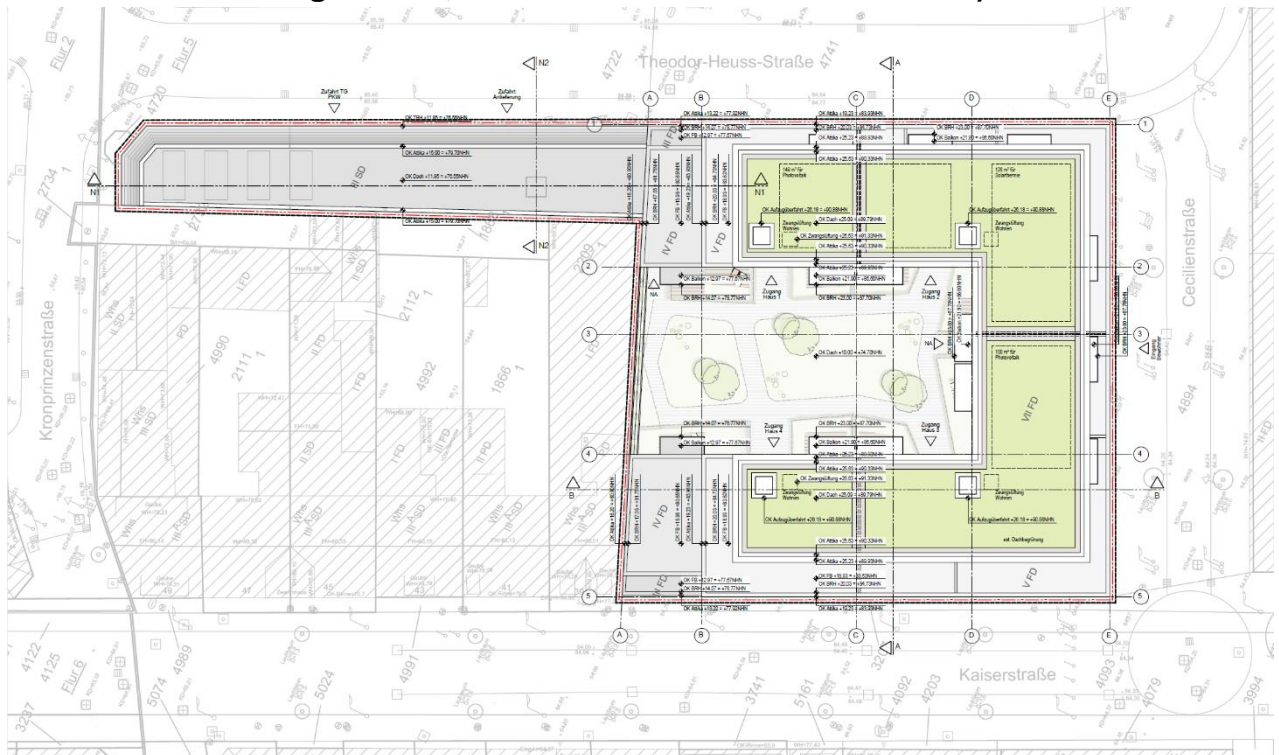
Ausschnitt des Lageplans mit Details der Dachaufsicht (ohne Maßstab, ungenordet, Quelle: schulte architekten GmbH).
